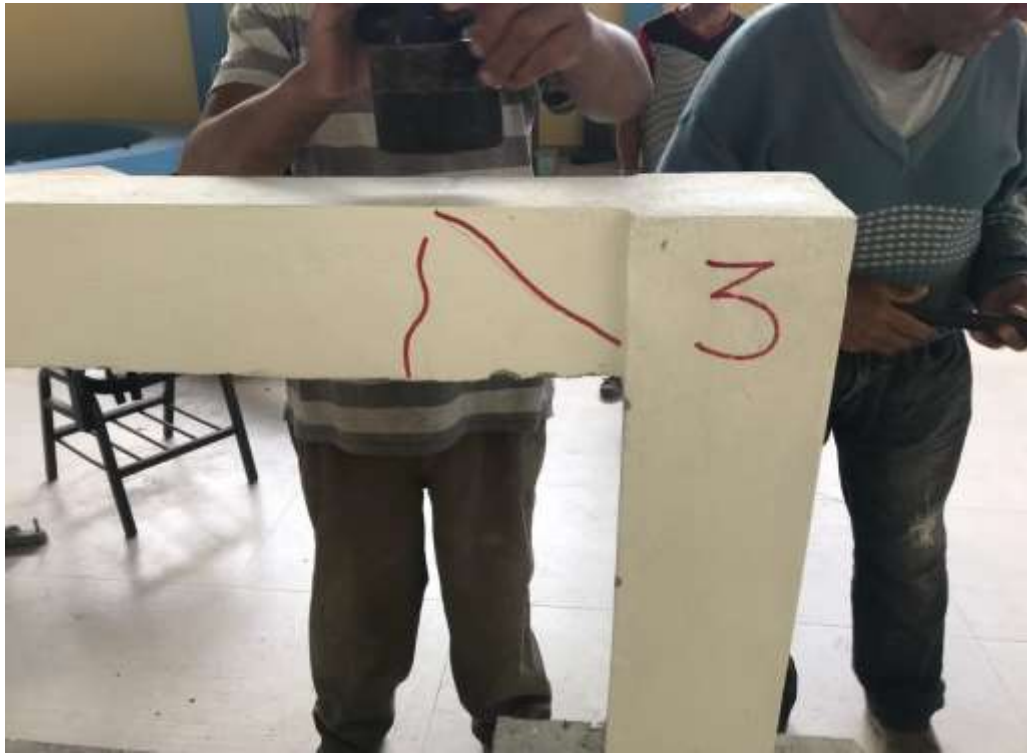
Falla producida por esfuerzo cortante en la viga de concreto armado con el primer estribo espaciado a 2.5 cm medido a partir de la cara de la columna.
